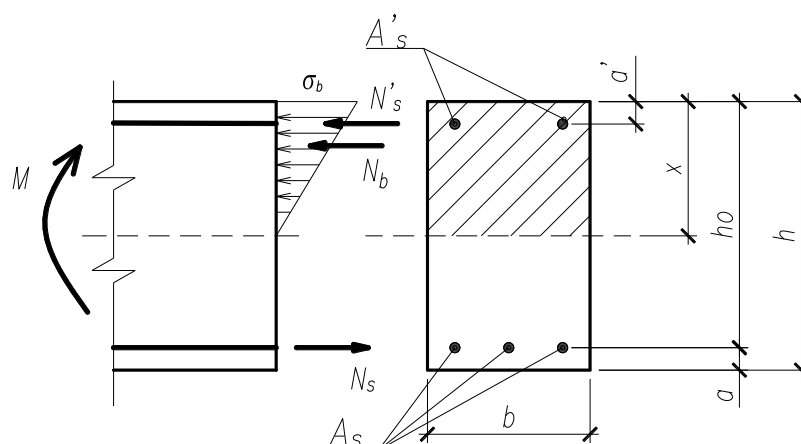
К расчету балки прямоугольного сечения по допускаемым напряжениям
